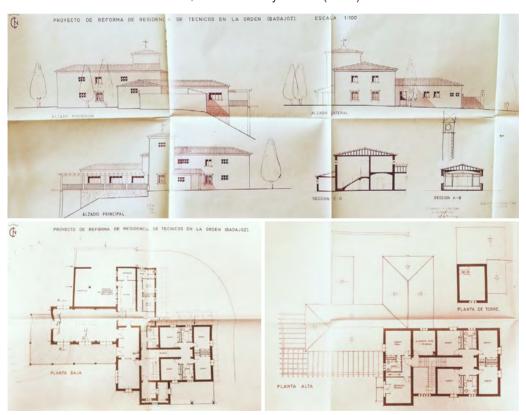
Proyecto de reforma en la Residencia de Técnicos en la Finca La Orden. Alzados y secciones. Plantas (1963). Archivo CEA. Mérida.
